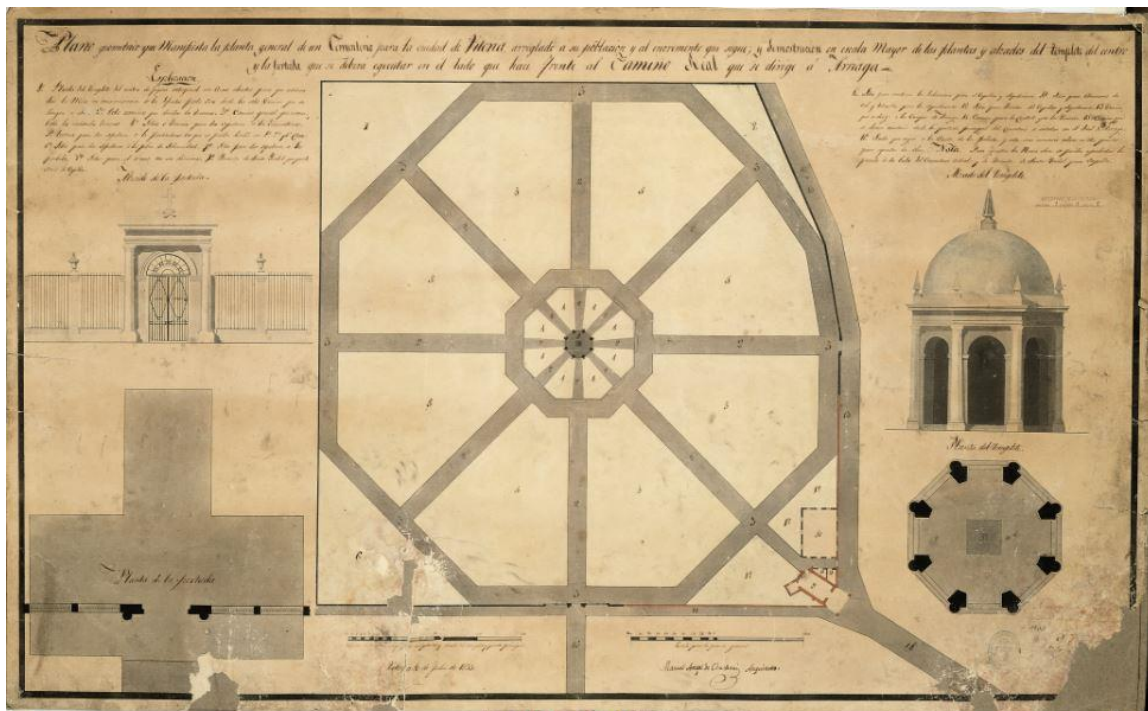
Plano que muestra la planta general del cementerio, de la capilla central y la portada principal y sus correspondientes alzados. Proyecto realizado por Chávarri, 1833. Foto: AMV.
